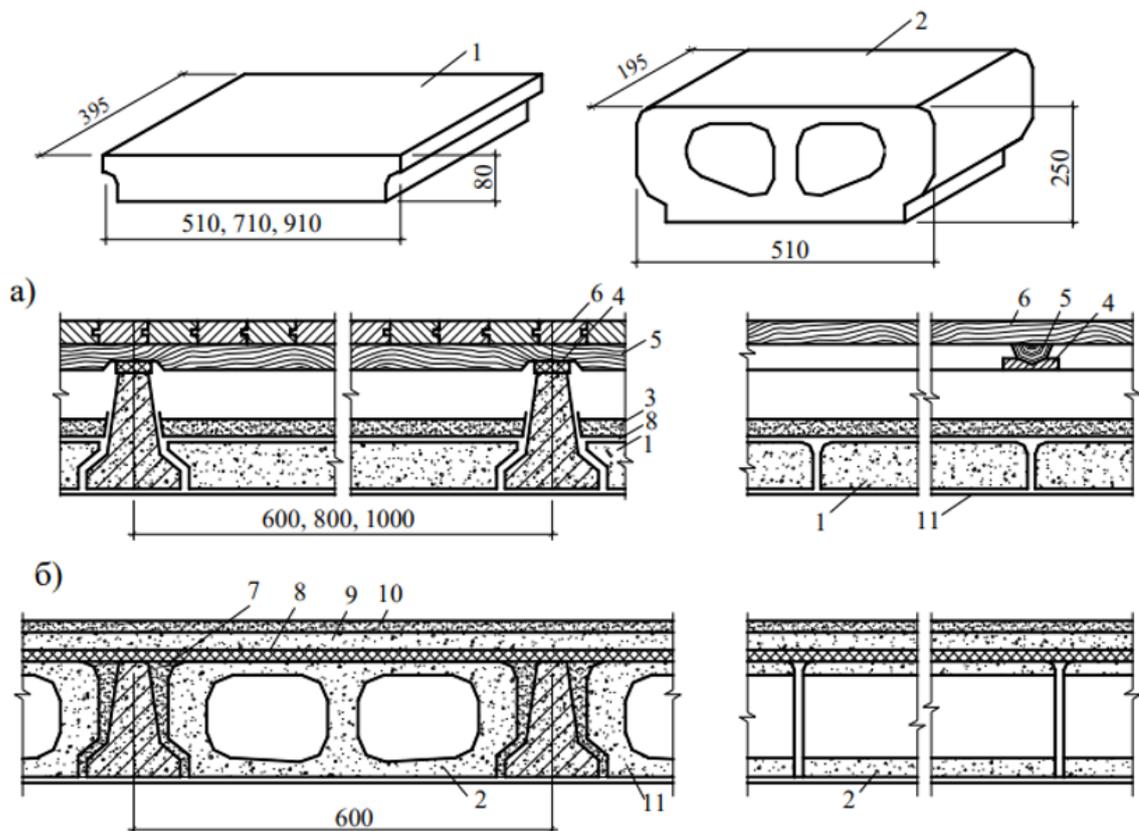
Міжповерхове перекриття по залізобетонних балках:
